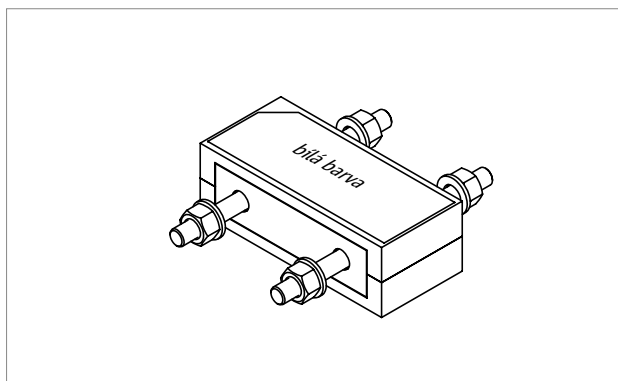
Schöck Isokorb® T typ S-N-D22: Řez prvkem
